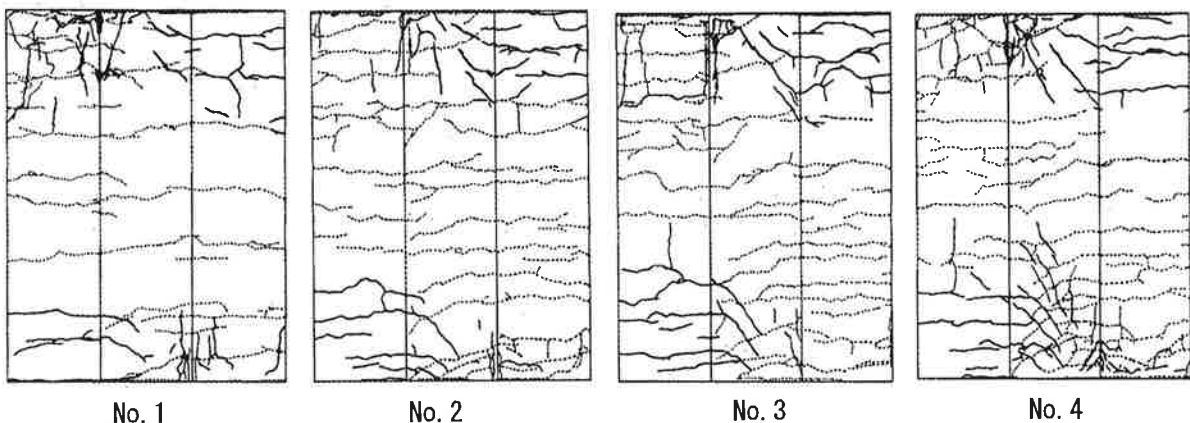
$R = \pm 2.0\%$ 時のひび割れ状況
